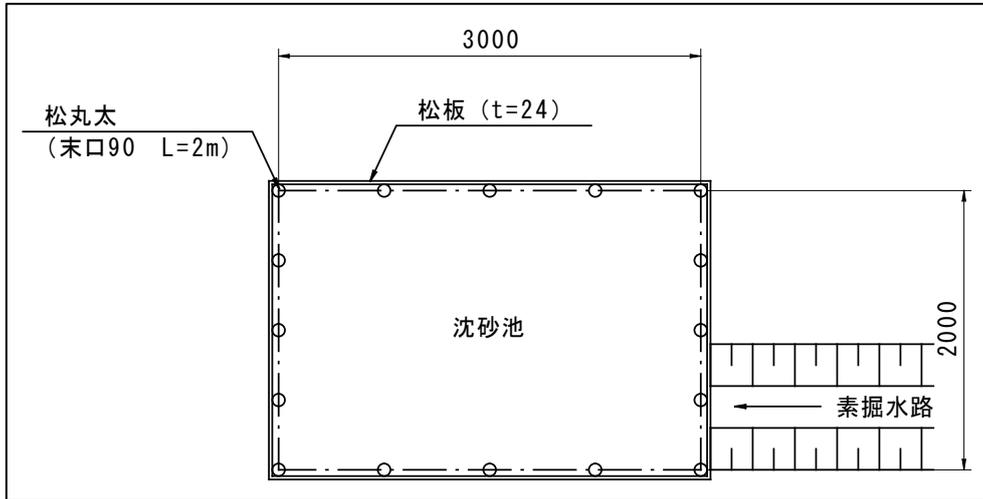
(1) 沈砂池の構造 (平面図)
